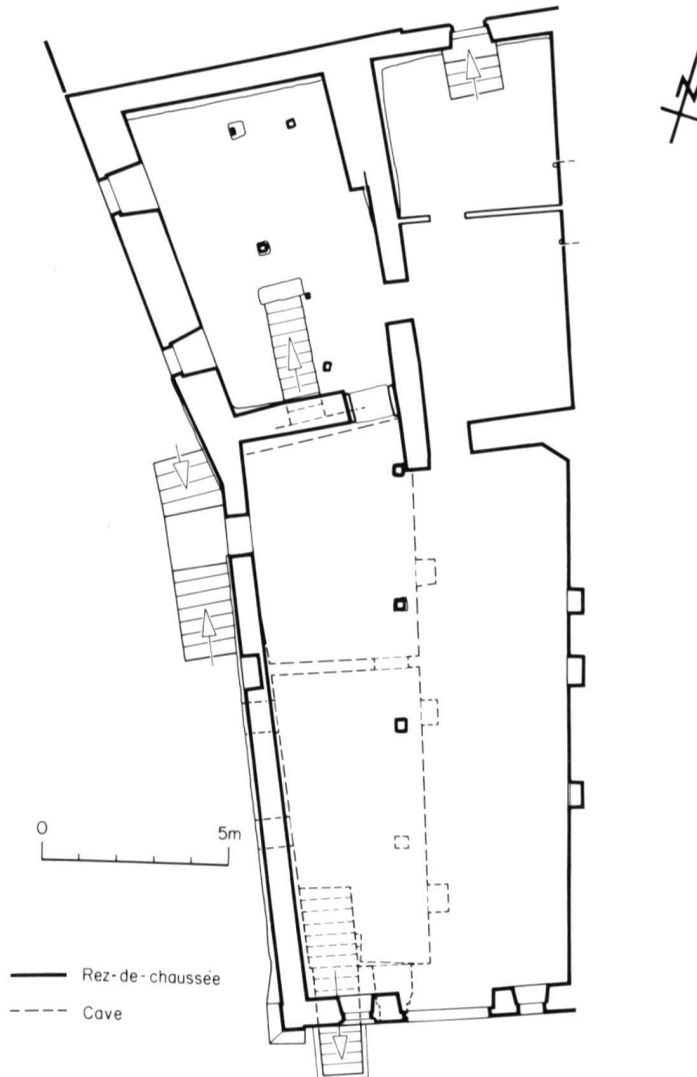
Fribourg / Rue d'Or 5. Plan de situation du rez-de-chaussée et de la cave (1:200)
